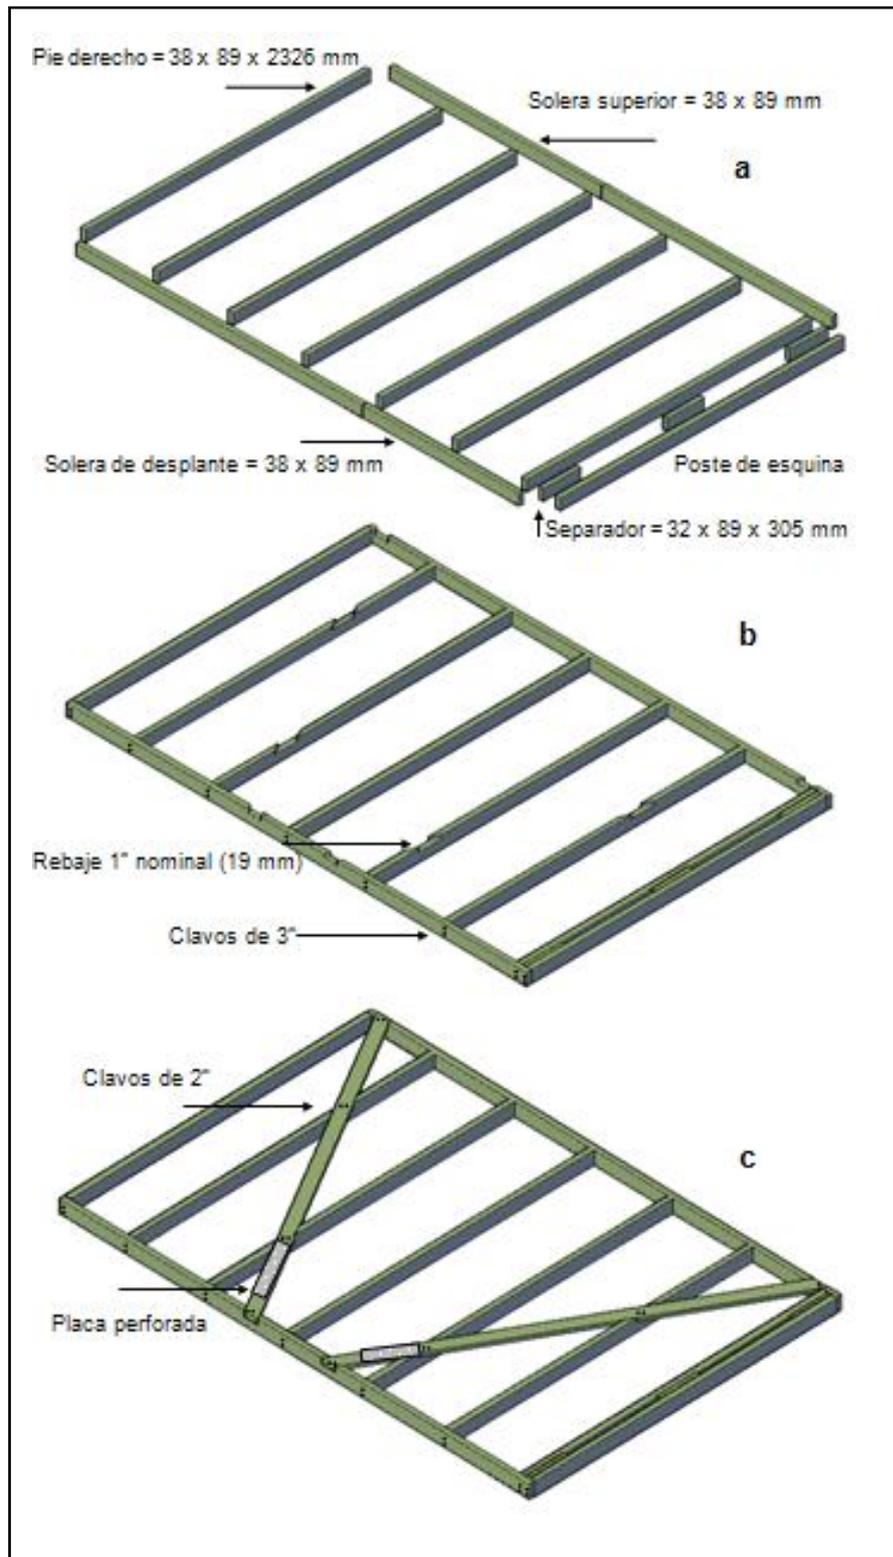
a) Colocación de las piezas para formar el marco; b) Recortes para la colocación de la riostra; c) Armado de las piezas del panel con sus riostras y la placa perforada.
